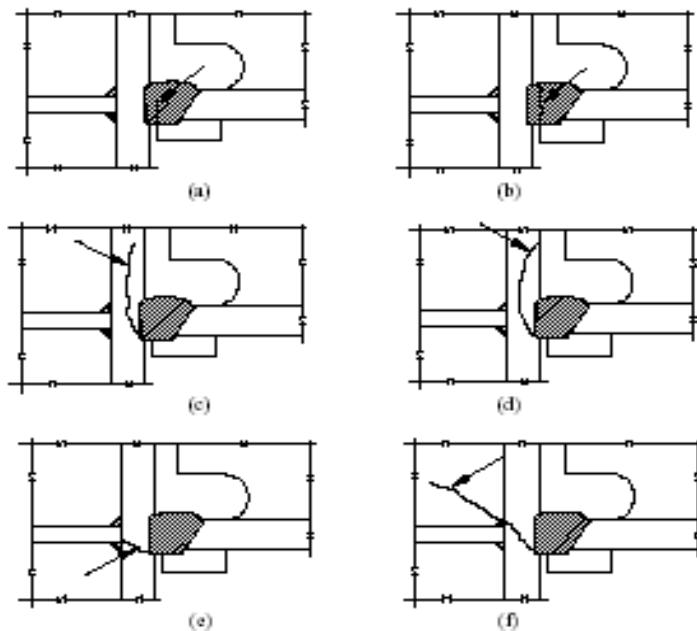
Tipos de fallas que se presentan en una conexión viga-columna de acero. Fuente EERC.
